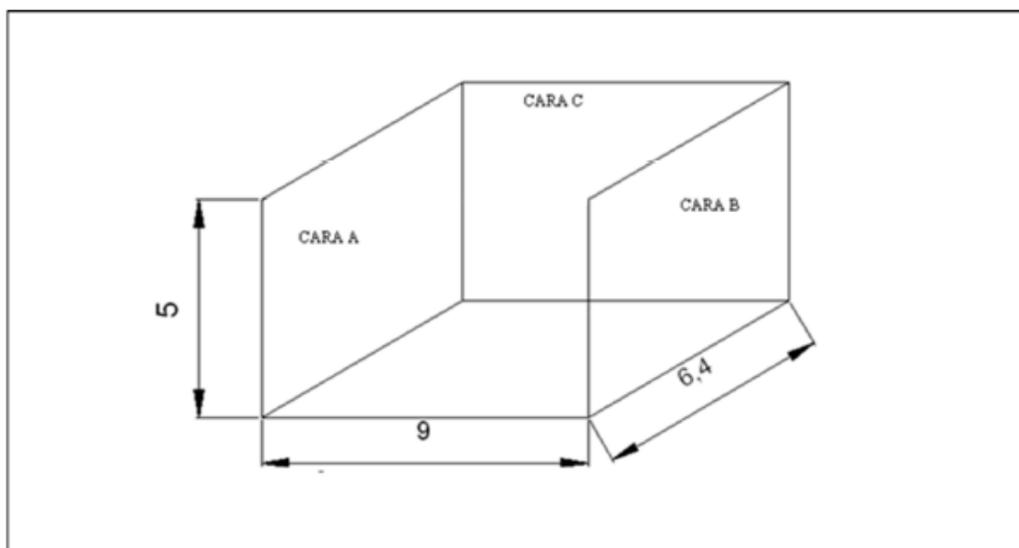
Dimensiones del bloque primario. (Unidad metro)
